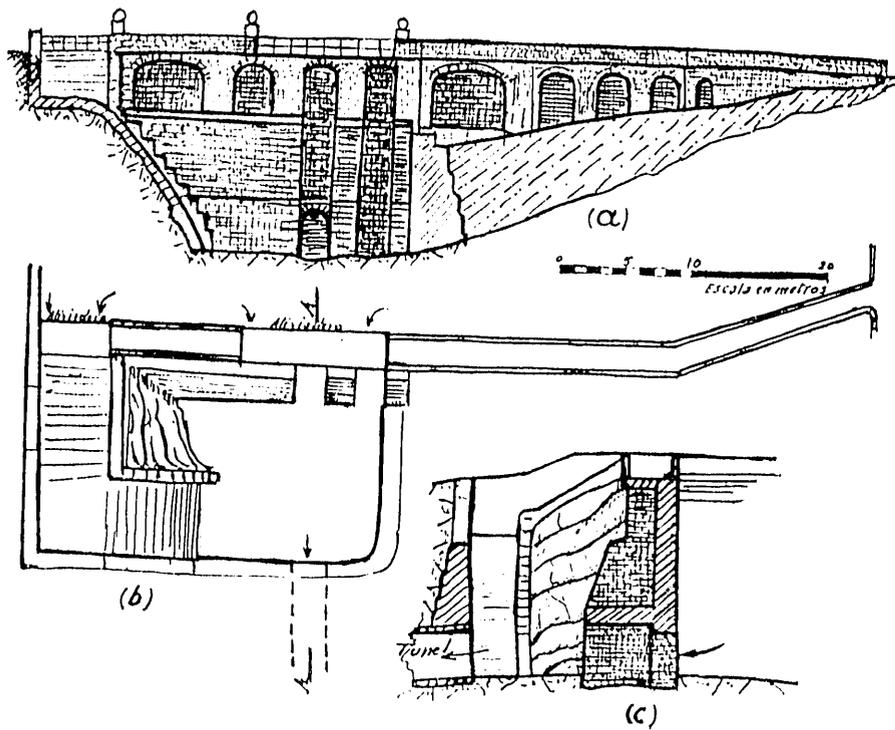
Apuntes con dimensiones a estima de la presa de La Olla. a) Alzado. b) Planta. c) Corte-proyección por el plano del desagüe de fondo.
